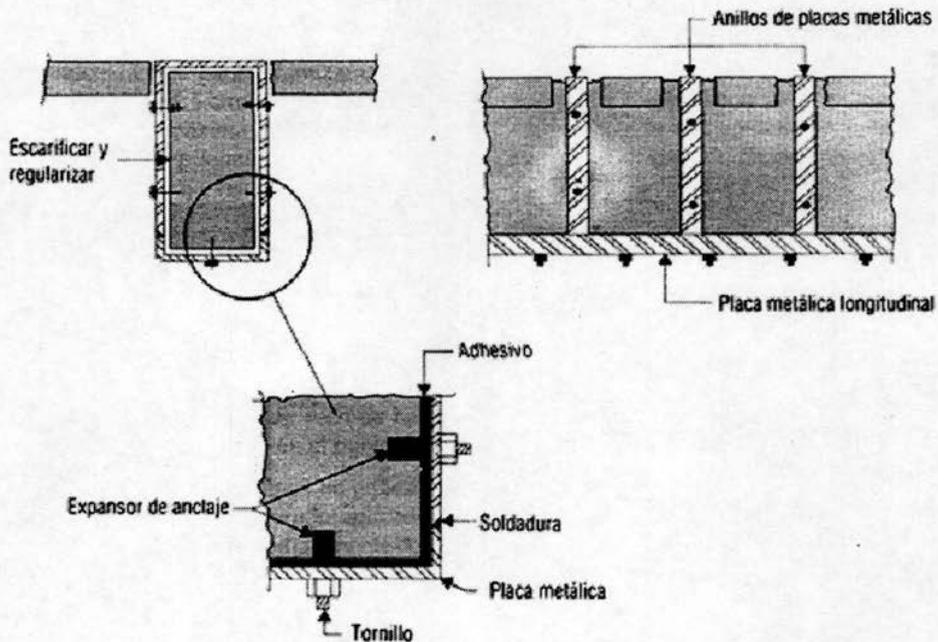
Refuerzos – torsión. Placas metálicas adheridas con resina epóxica
